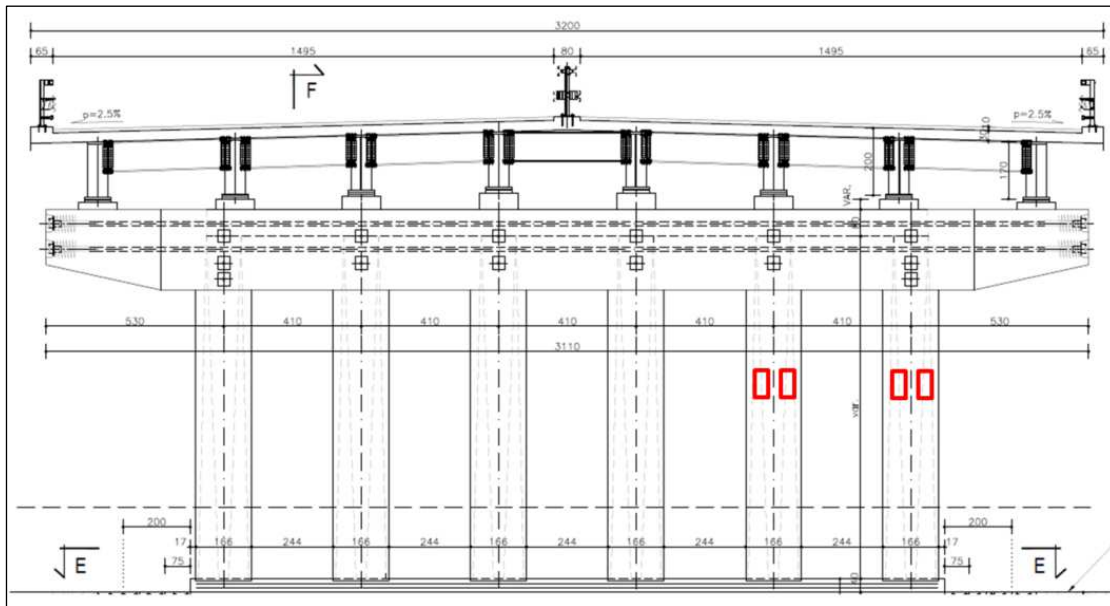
Localizzazione indicativa delle bat box (in rosso) sulle pile a pilastro, lato sud viadotto
